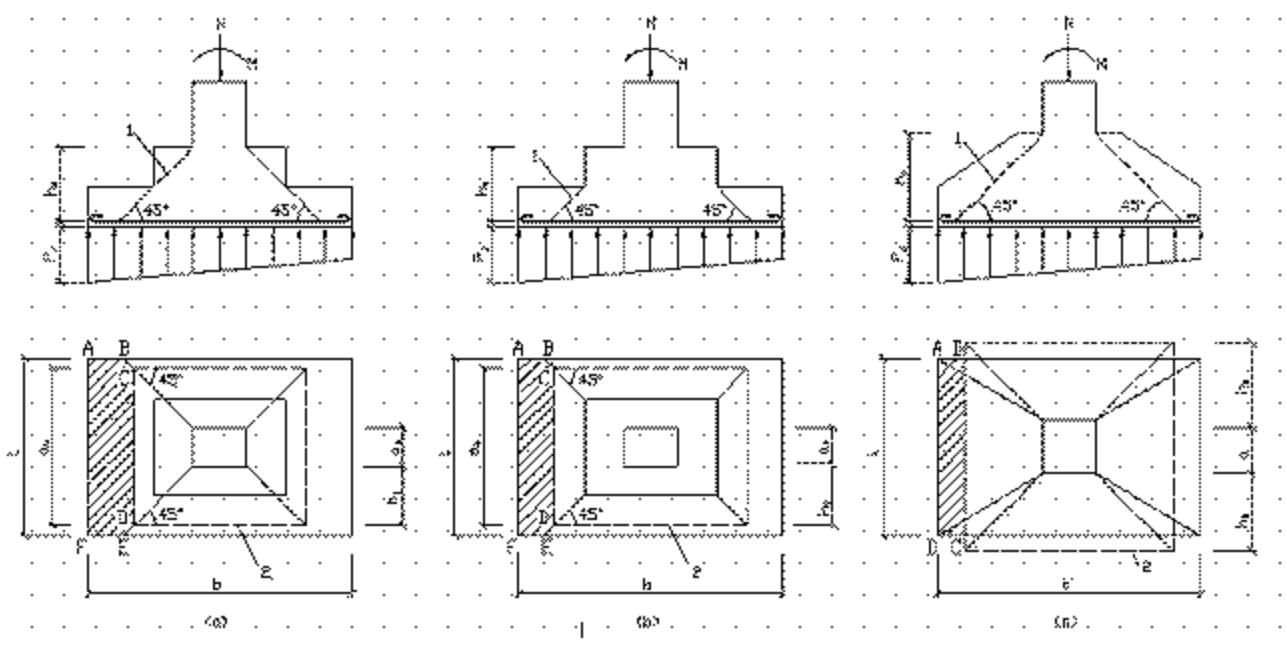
计算阶形基础的受冲切承载力截面位置
